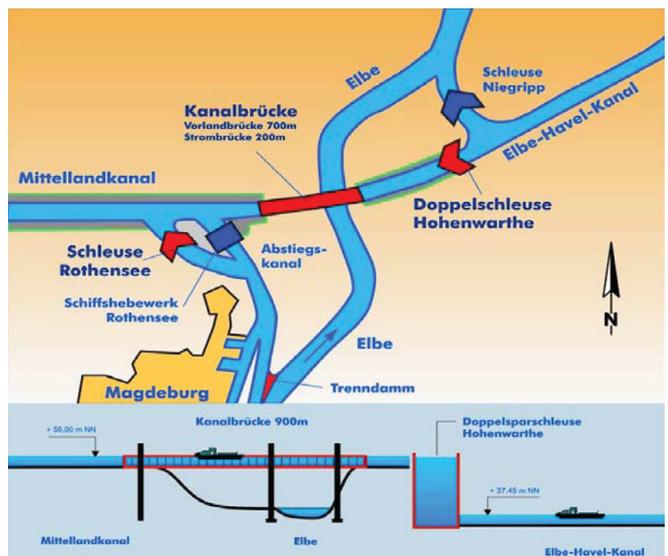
Lage der Kanalbrücke im Wasserstraßenkreuz Magdeburg
